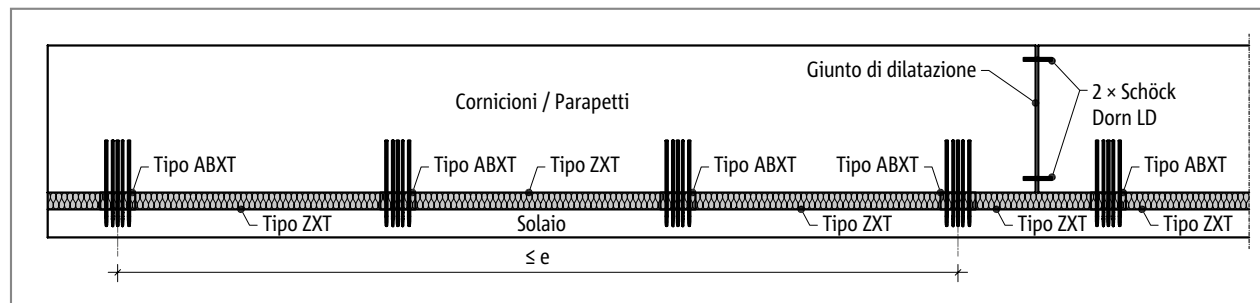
Schöck Isokorb® tipo ABXT: disposizione dei giunti di dilatazione
